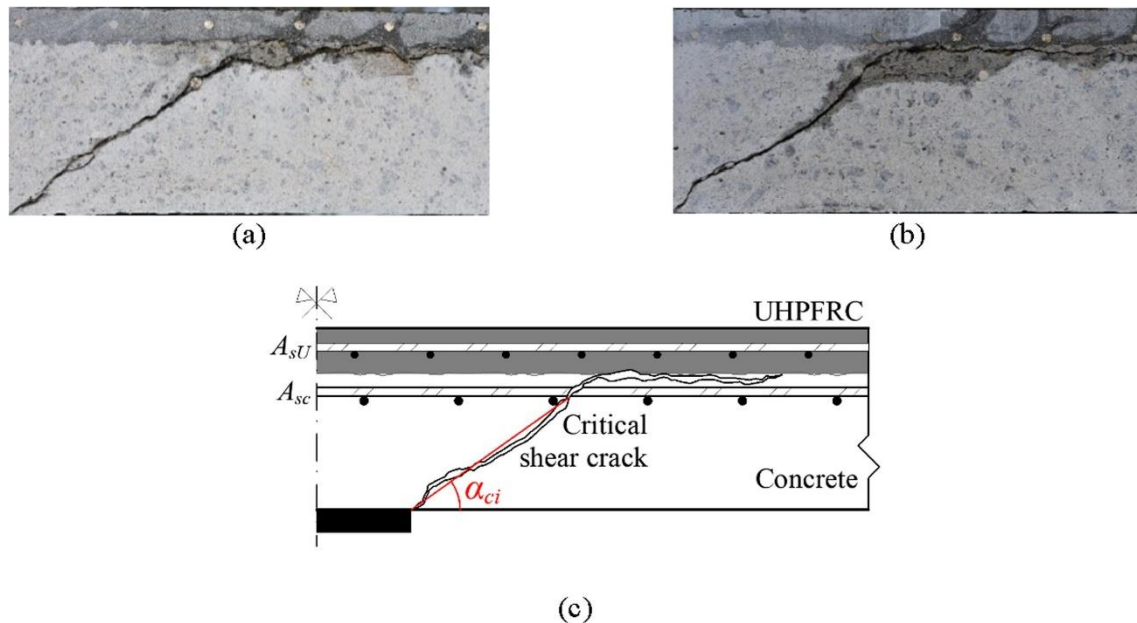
fissura na interface de contato entre concreto e UHPFRC: (a) direção sul; (b) Leste; (c) detalhamento da inclinação da fissura.
